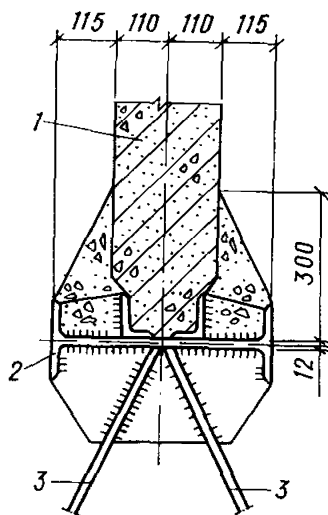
Крепление стальной воронки к железобетонным элементам
